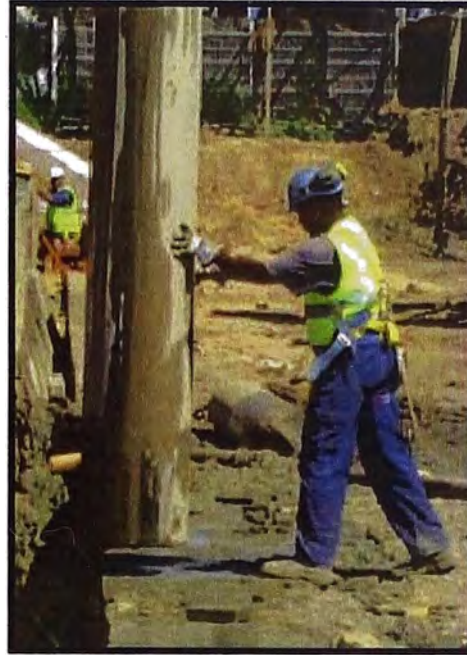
Colocación de las Juntas para la construcción de los muros pantalla.
